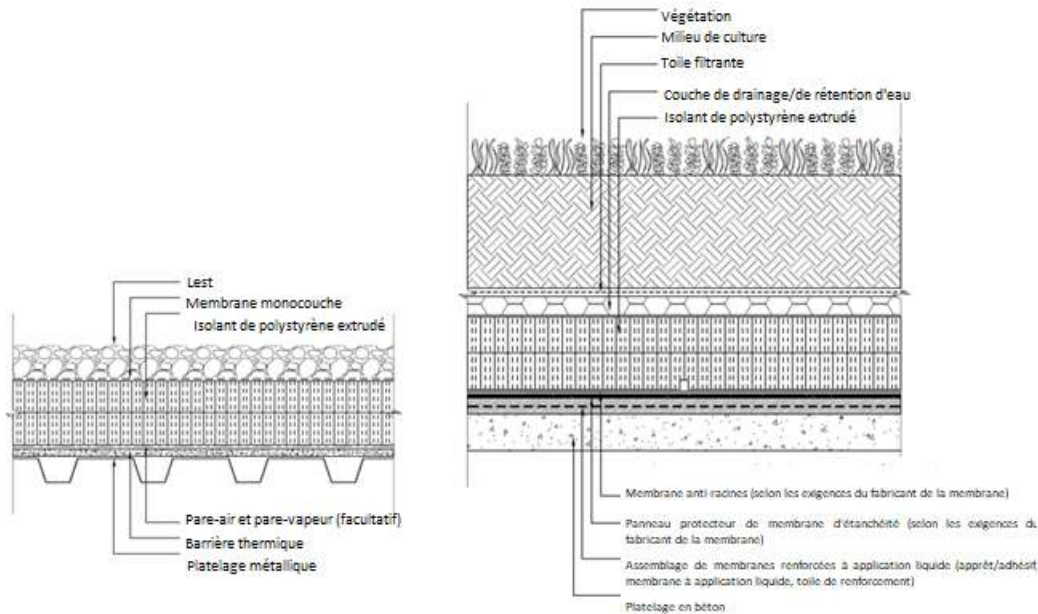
On désigne parfois la TMP d' « assemblage de toiture inversée », car les panneaux isolants de PSX sont placés sur la membrane de toiture. Ici, on fait la comparaison entre un assemblage de toit monocouche classique sur un platelage métallique (à gauche) et une TMP (à droite) comprenant des couches de toit végétalisées.
